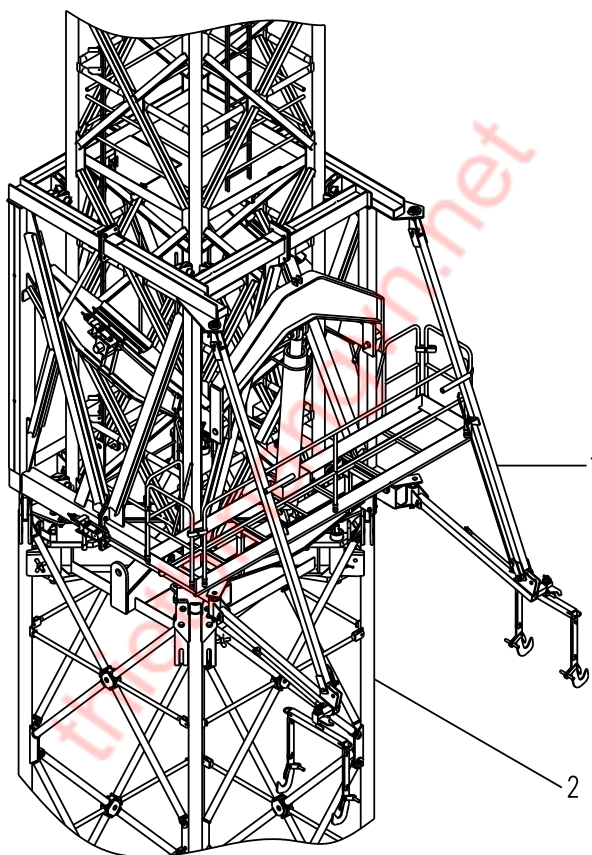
安装顶升套架 Fig. 4-11 Fitting Telescopic Cage
